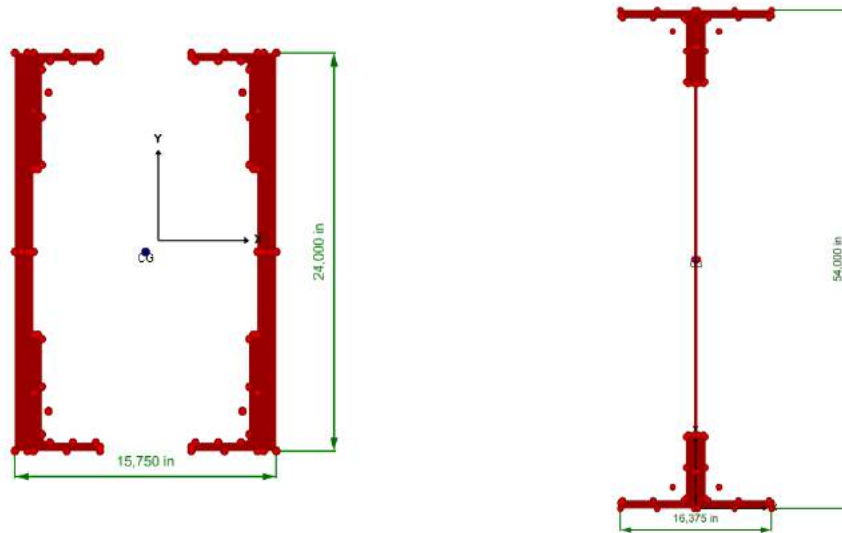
Coupes sectionnelles de la corde inférieure de la ferme (à gauche) et de la poutre principale (à droite)
